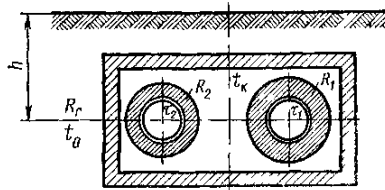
Расчетная схема двухтрубного теплопровода канальной прокладки
